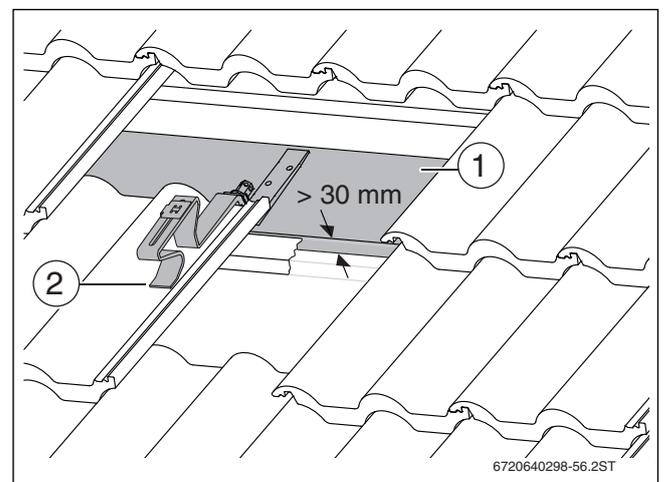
Montare il travetto inclinato su un'asse/una tavola
